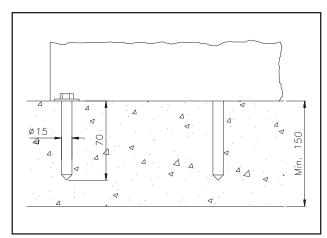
Foratura del pavimento Fig.27 Floor drilling.
